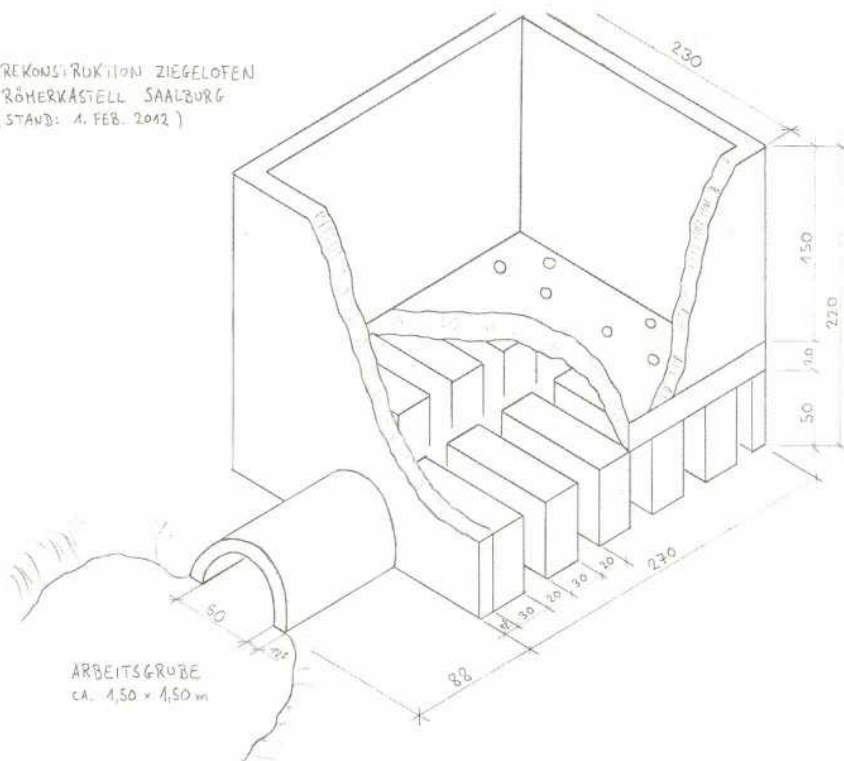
Rekonstruktionsentwurf des Ziegelofens. – Sketch of the brick kiln reconstruction.
